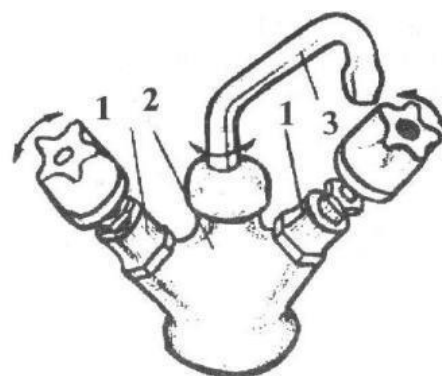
Смеситель: 1 — вентиляционная головка; 2 — корпус;
